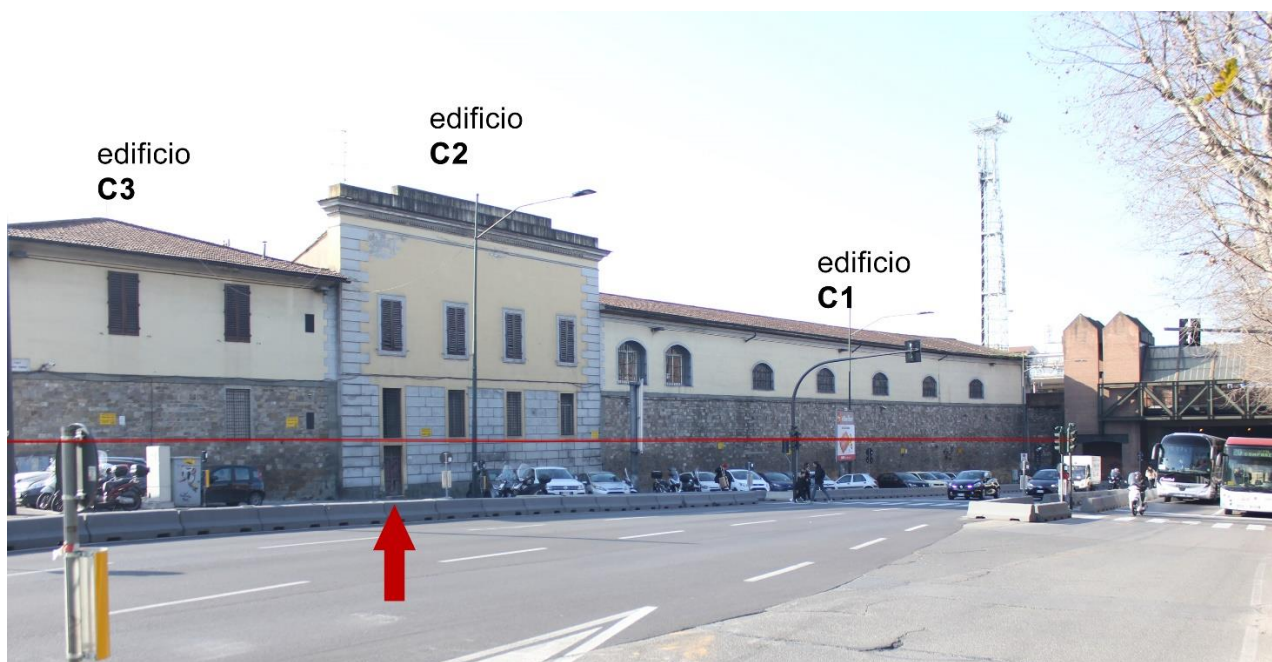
linea di demarcazione e nuovo ingresso all'edificio C2 realizzato a seguito dell'abbassamento di viale F. Strozzi.
